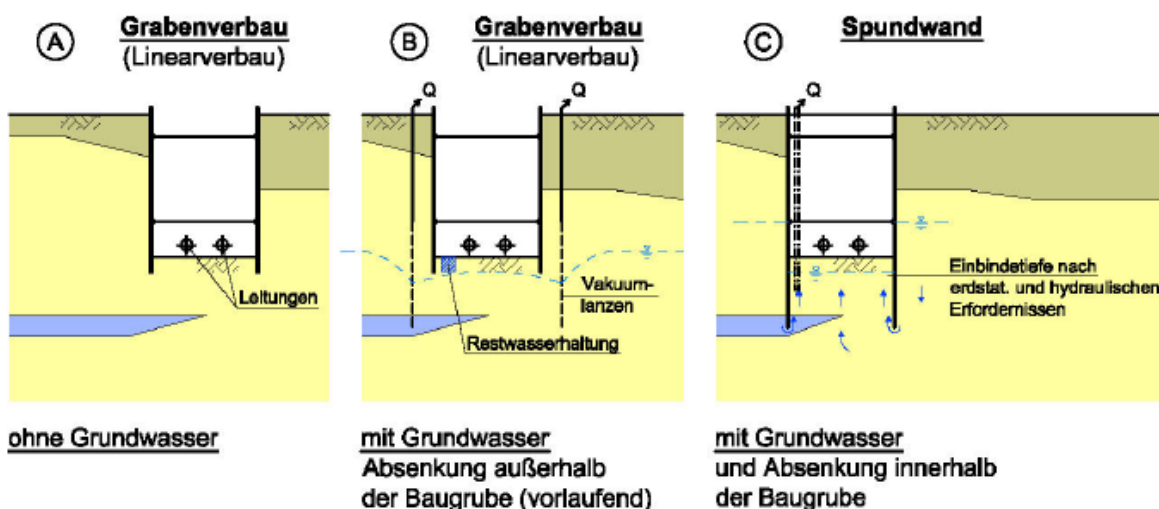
Baugrubenverbau - mit und ohne Grundwassereinfluss
